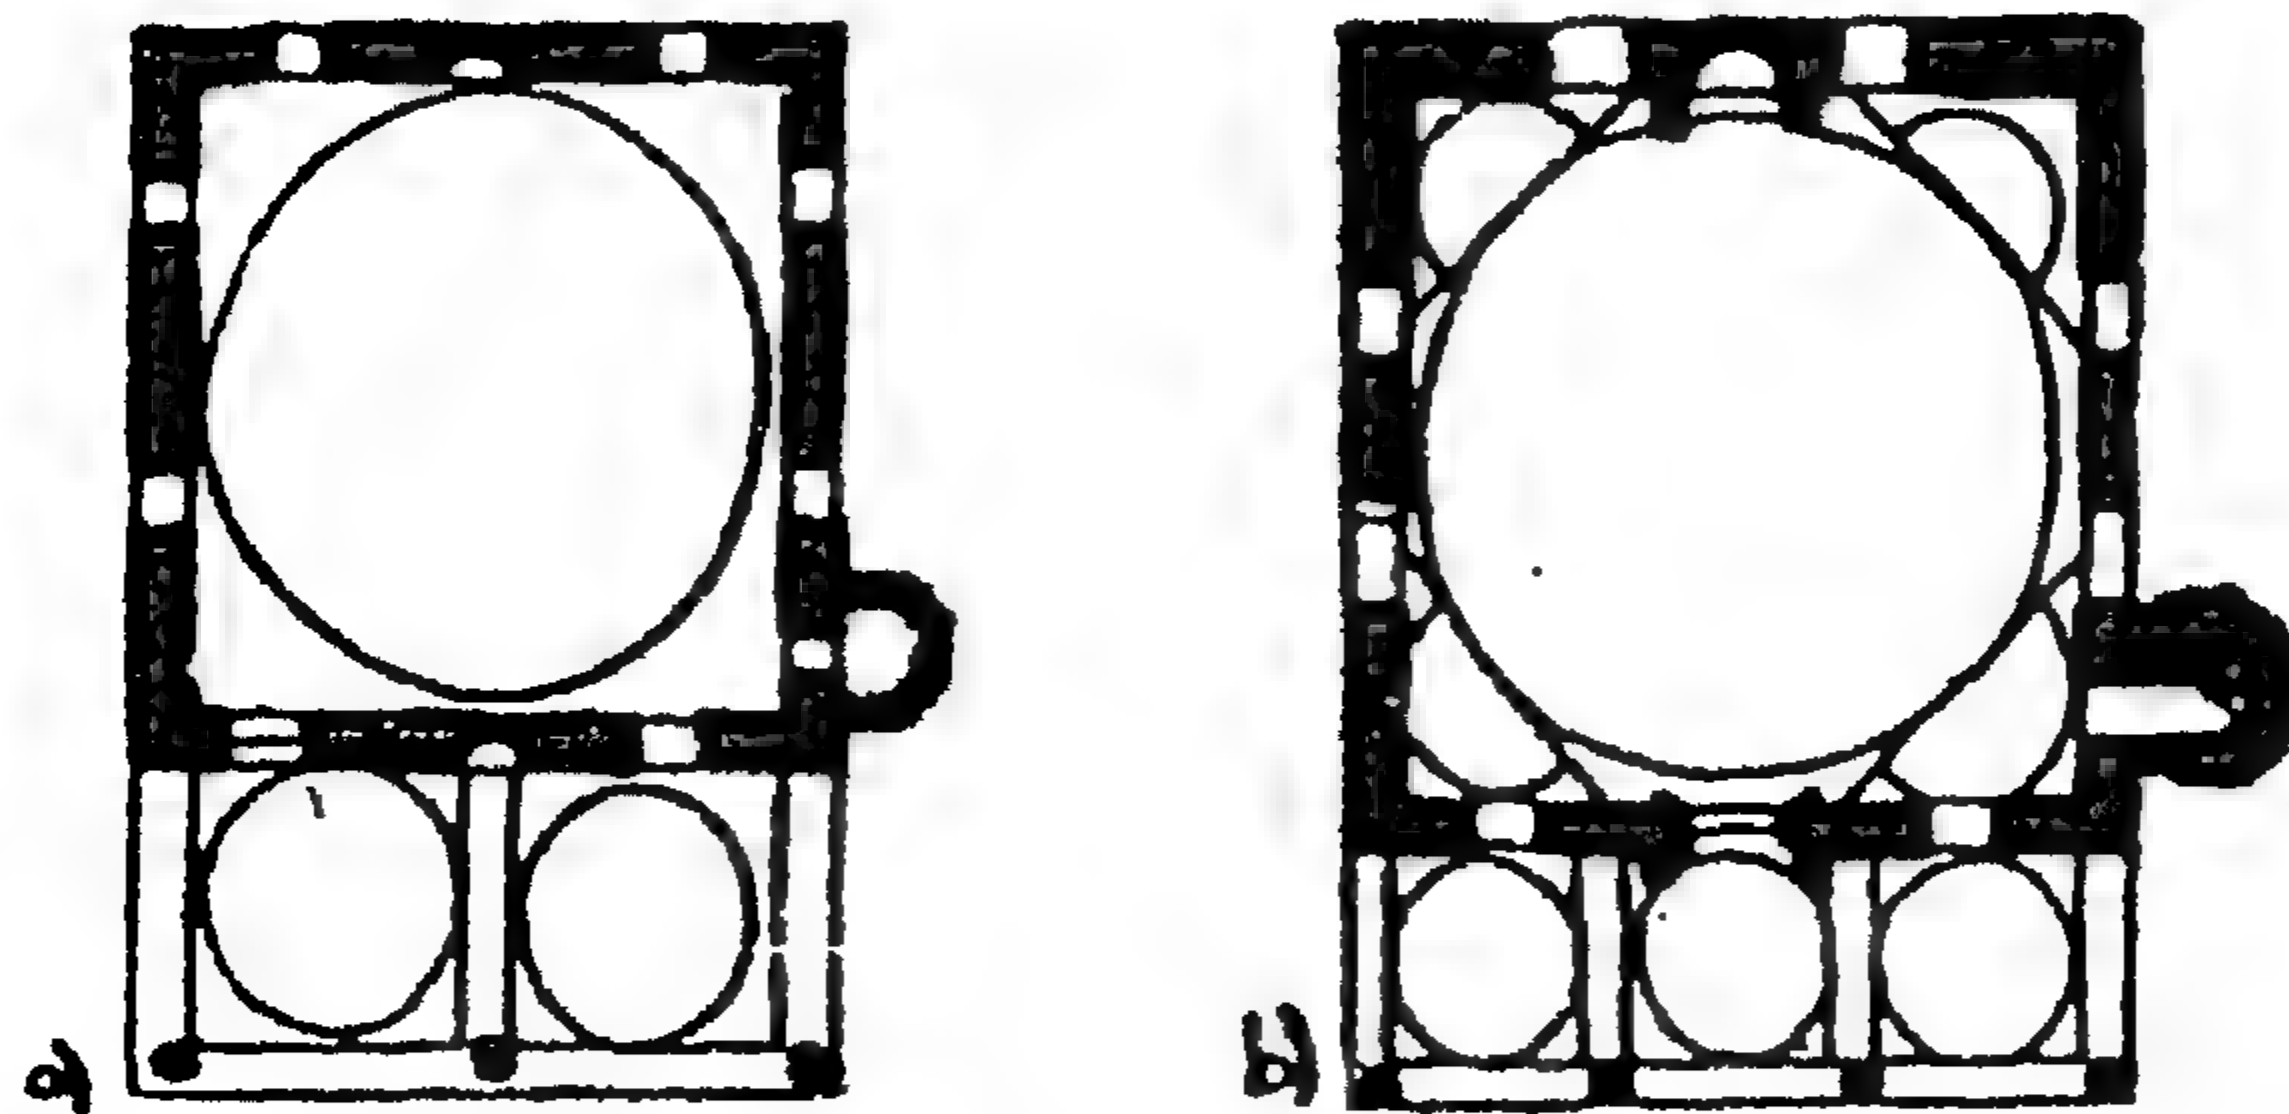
مسقط أفقي لمسجد ياكوفالي حسن باشا في Pécs المجرية (عن : جيرو) .
